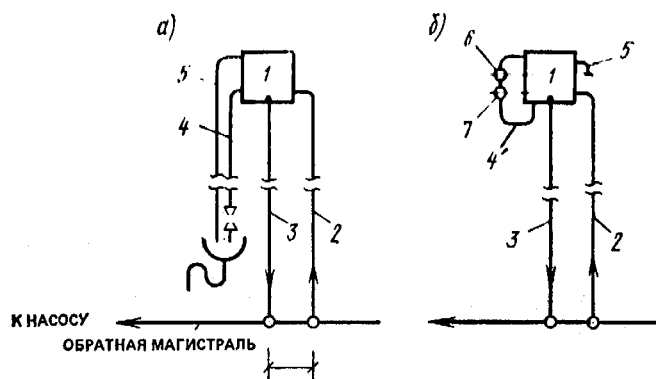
Присоединение открытого расширительного бака к системе отопления
